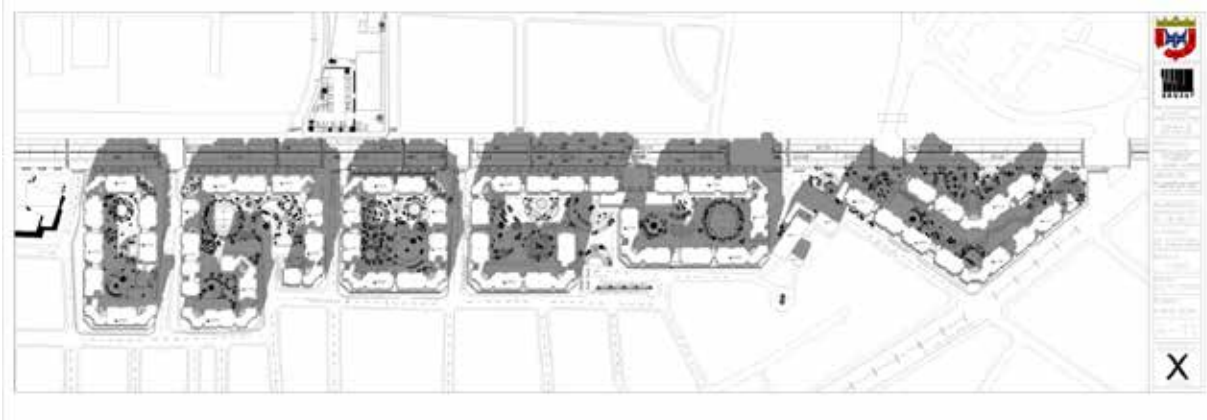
Planta Techo Conjunto. Autora (2020).
